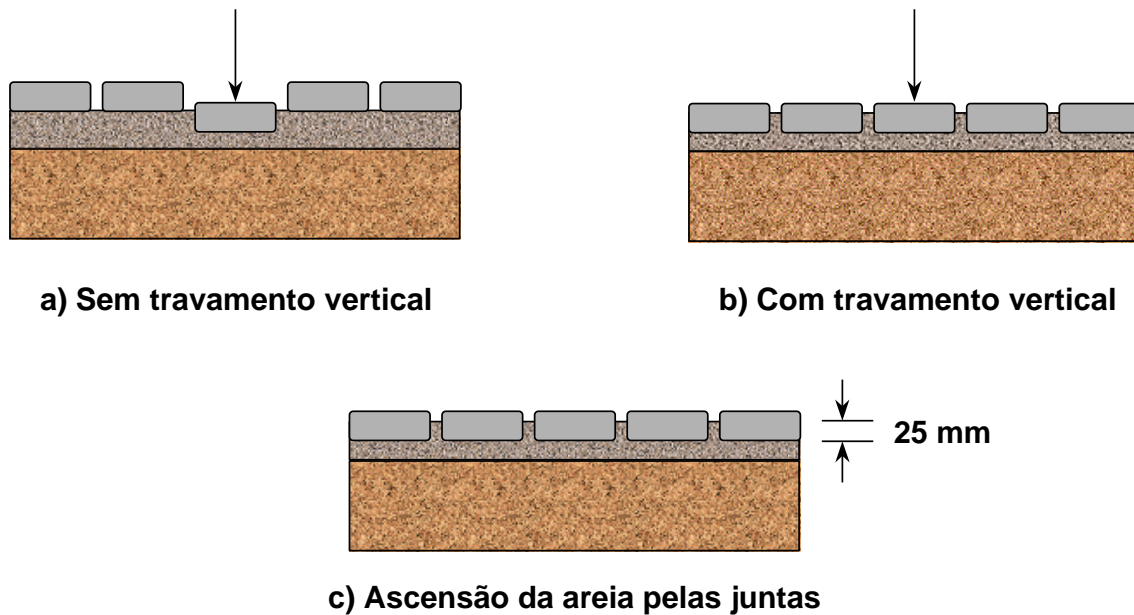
Intertravamento vertical (HALLACK, 1998).
